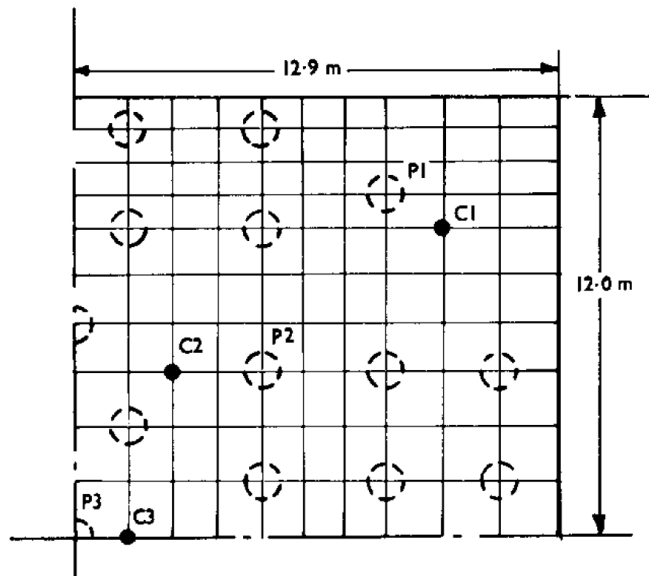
Fundación en Placa Piloteada para el Hyde Park (S. J. Hain & Lee, 1978)
